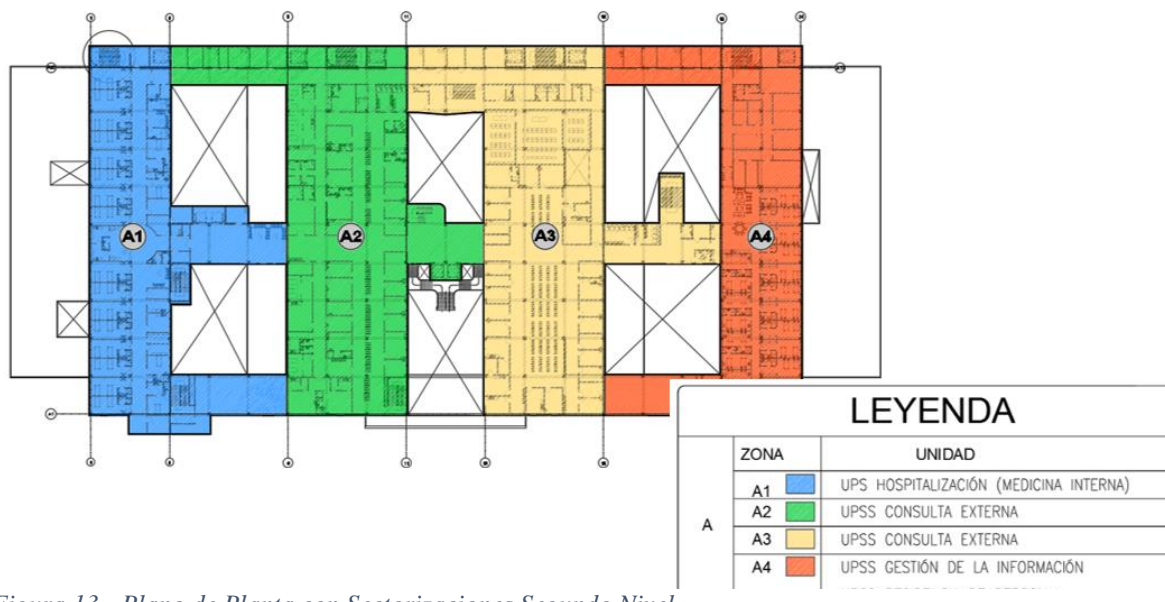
Plano de Planta con Sectorizaciones Segundo Nivel
